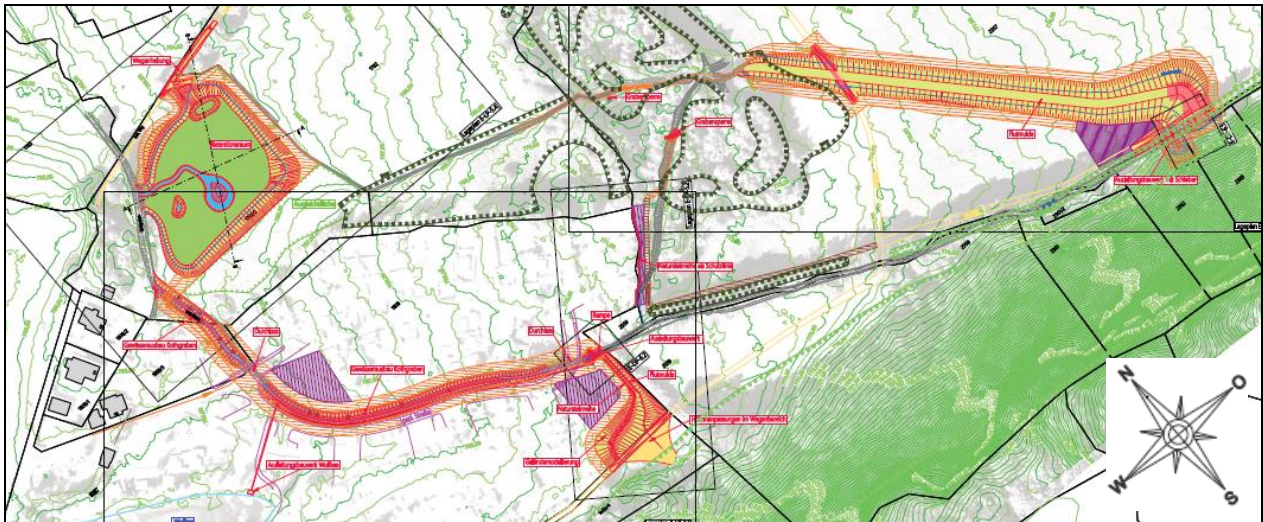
Lageplan geplante Maßnahme (Quelle: aquasoli 2019, Anlage 2.2 der Antragsunterlagen)
